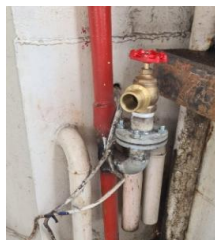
9 FFA *Sprinkler* KMP. Barau
